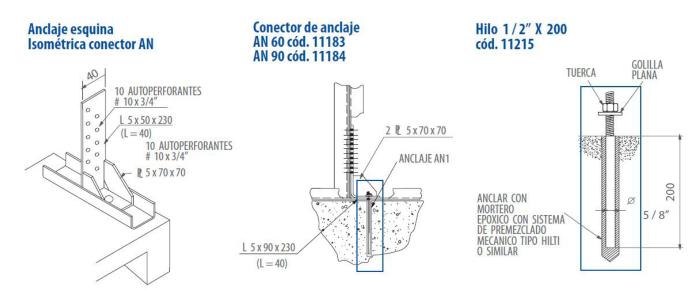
Sistemas de anclaje metalcon-Hormigón Armado. Fuente: Catálogo técnico perfiles y estructuras metalcón.
